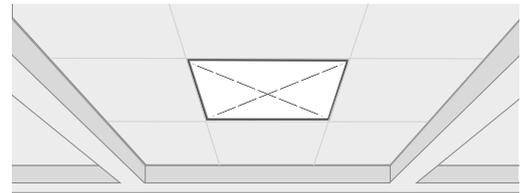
Variante 1 - Installation encastrée dans un plafond acoustique/à caissons
